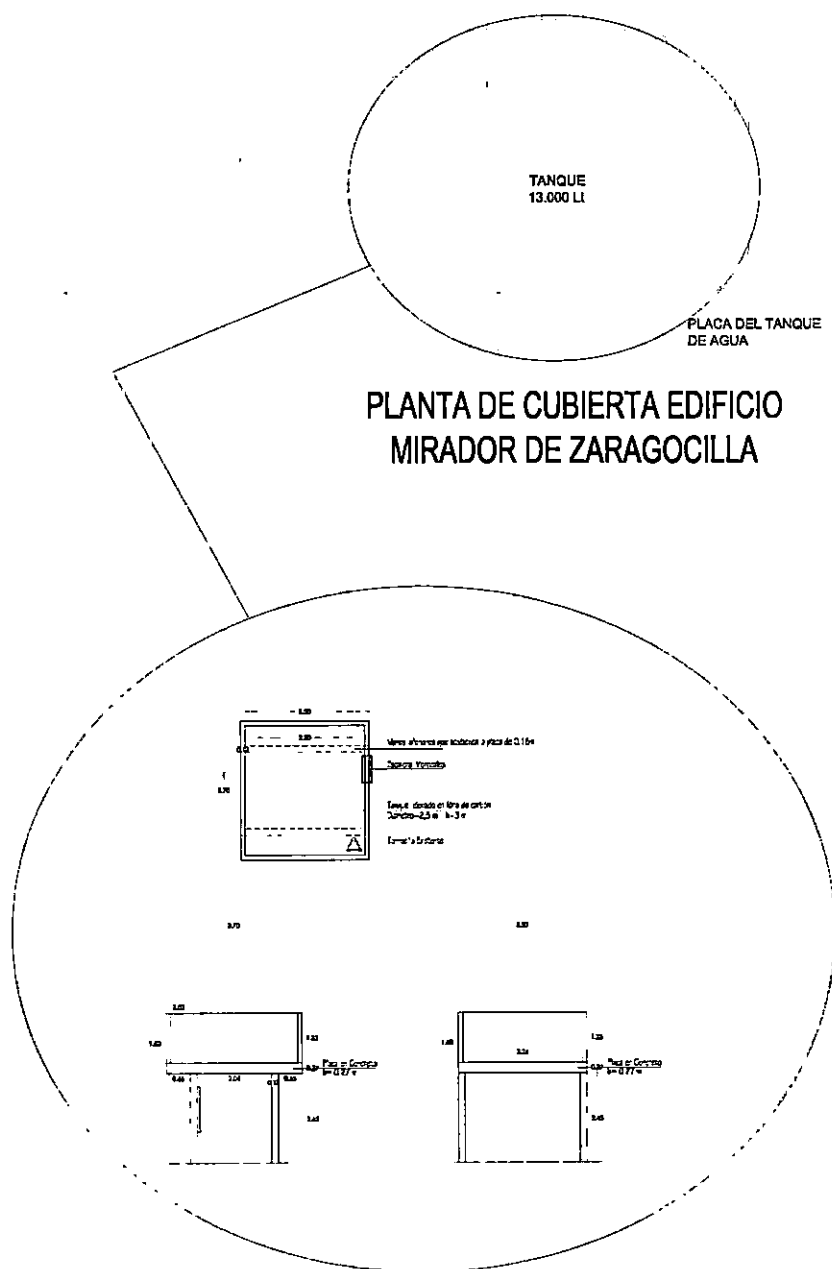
Cubierta edificación y Detalle de Placa Tanque
